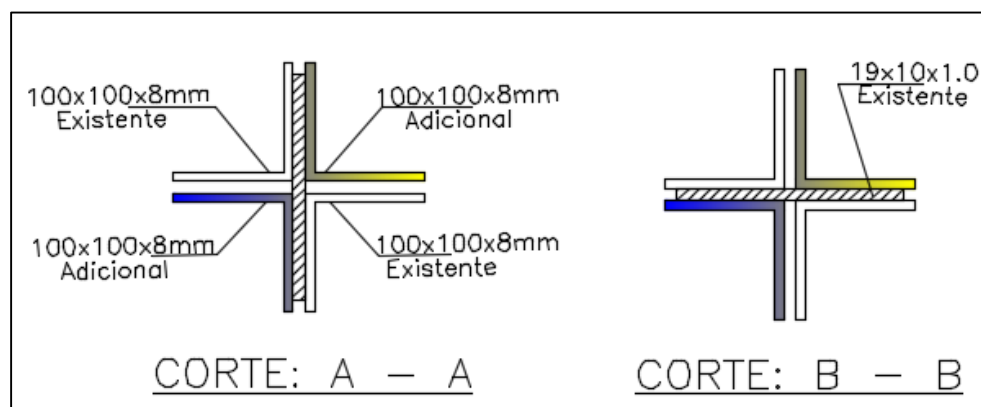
Sección Original (izq.) y Sección Reforzada (der.) rigidizadores inferiores apoyos Tramo B2B3.
